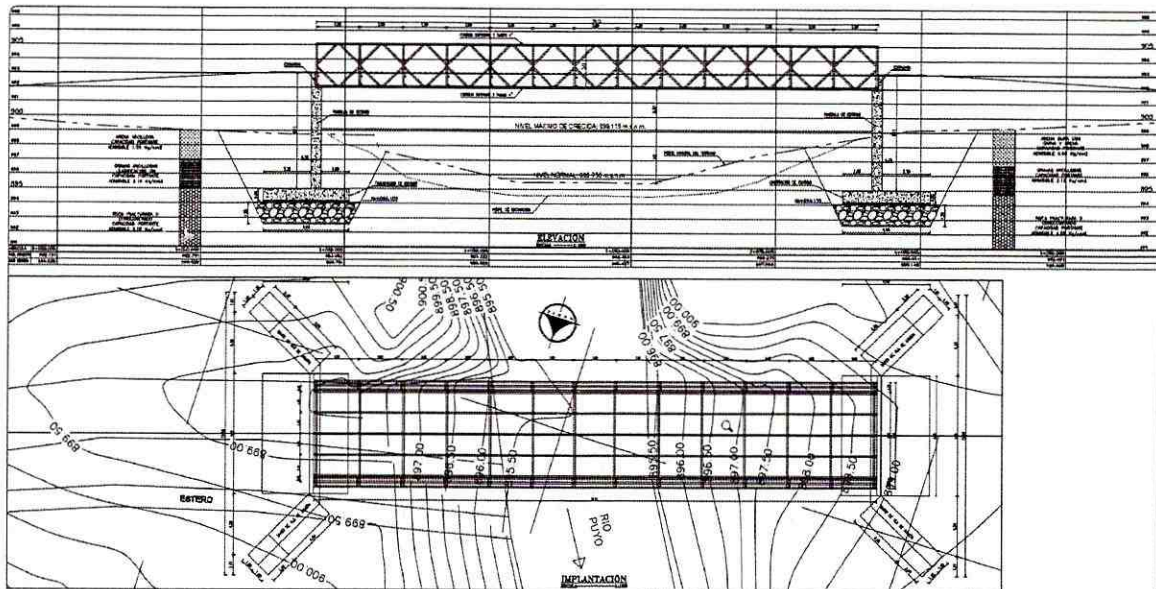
Implantación de las estructuras del puente sobre el Río Punin
